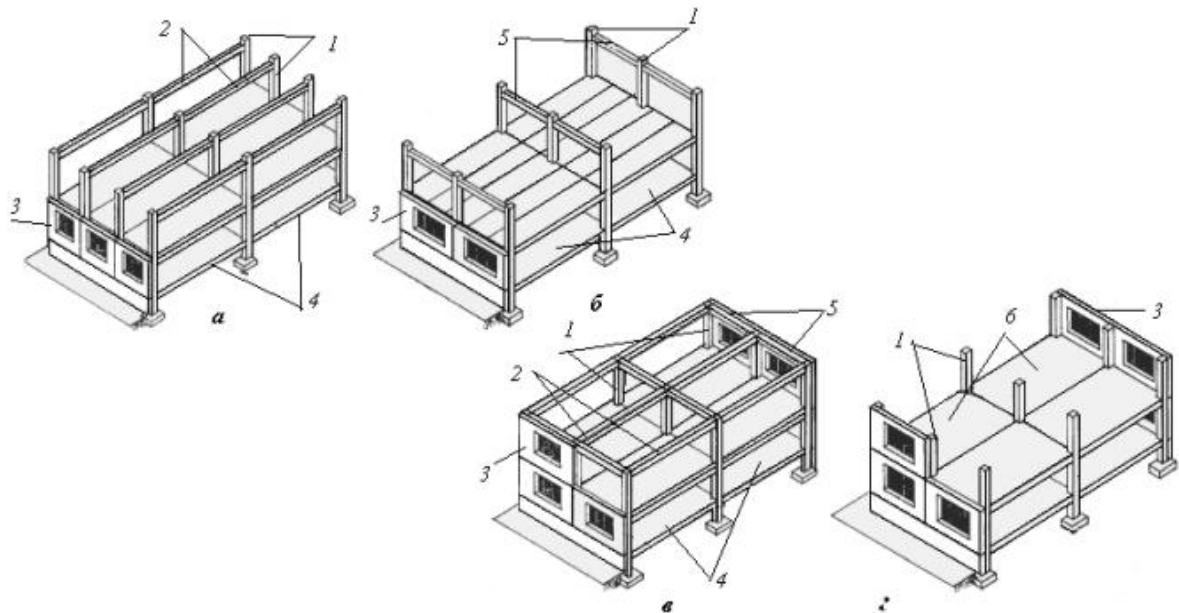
3 - Конструктивні схеми каркасних будівель: а – з поперечним розташуванням ригелів; б – з поздовжнім розташуванням ригелів; в – з перехресним розташуванням ригелів; г – безригельна. 1 – колони; 2 – ригелі; 3 – самонесучі стіни; 4 – плити міжповерхового перекриття; 5 – поздовжній ригель; 6 – між колонні плити перекриття
